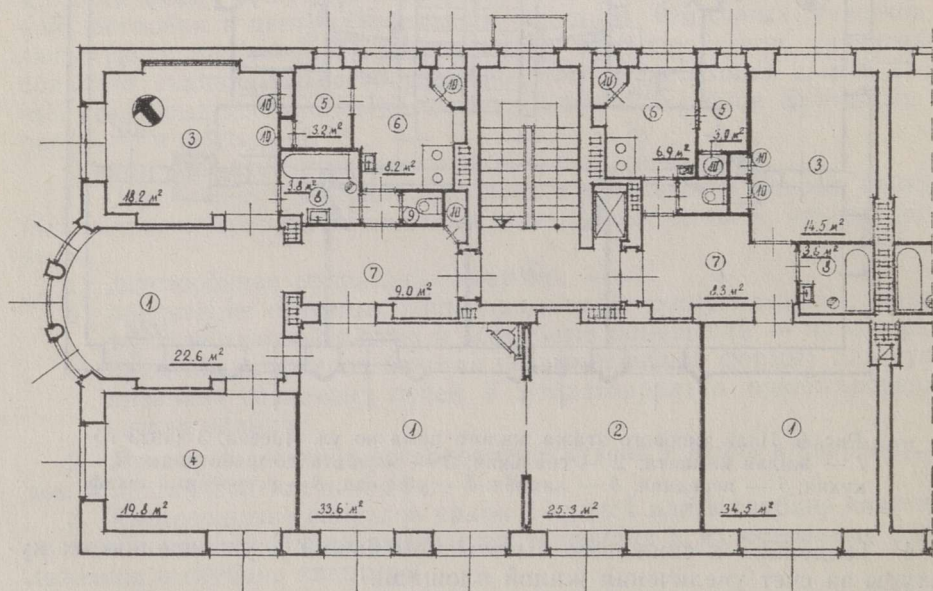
План типового этажа жилого дома по ул. Ломоносова, 43 (1937 г.):
